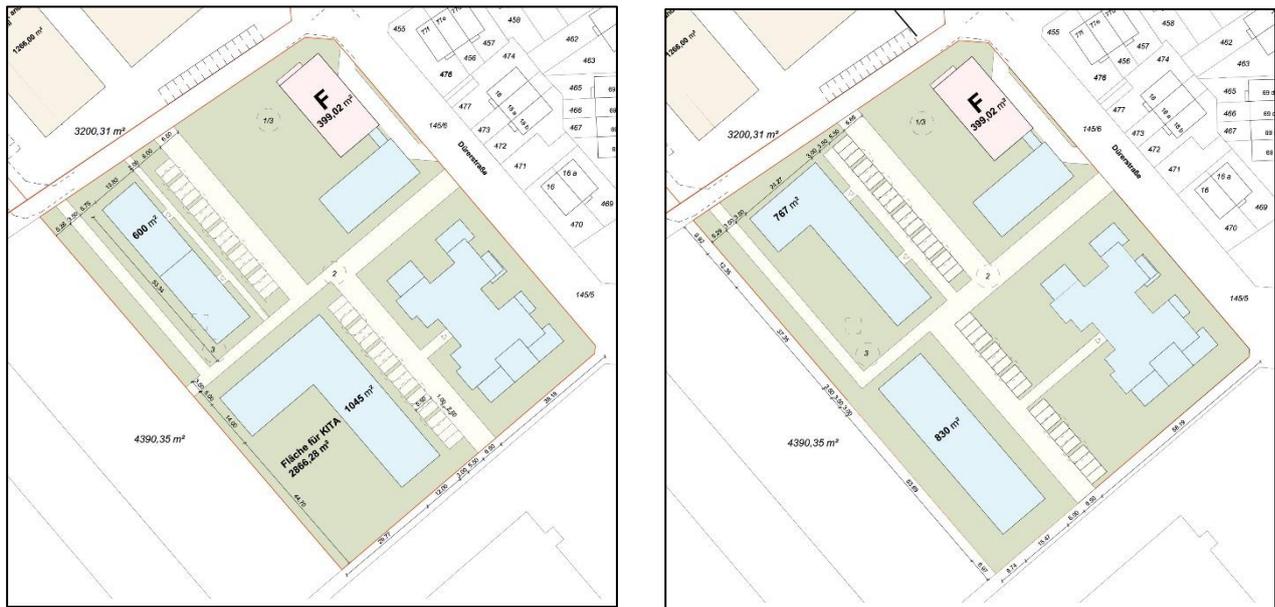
Städtebauliches Konzept Südteil mit Alternative
